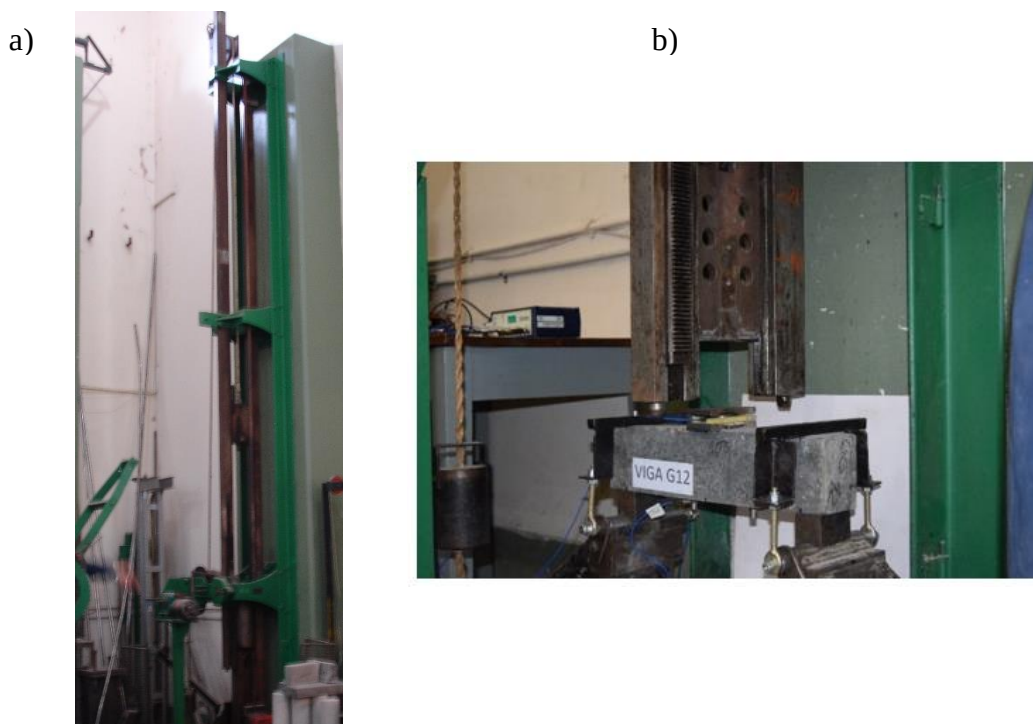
Vista de la máquina de impacto empleada. a) Vista lateral, b) Proyectil, espécimen y apoyos.
